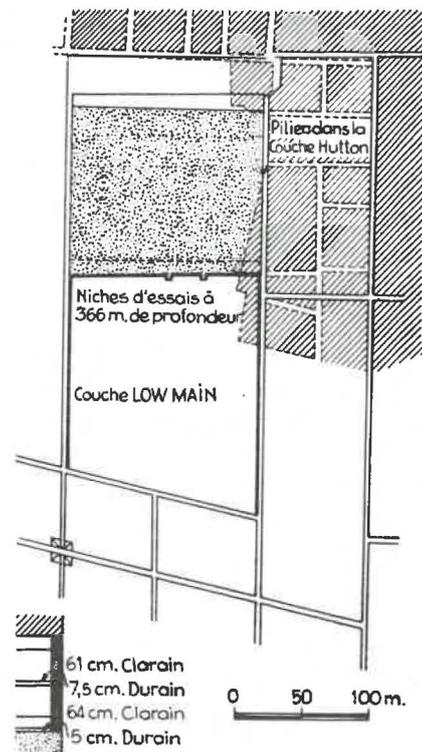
Plan donnant la situation des essais dans la couche Low Main.
